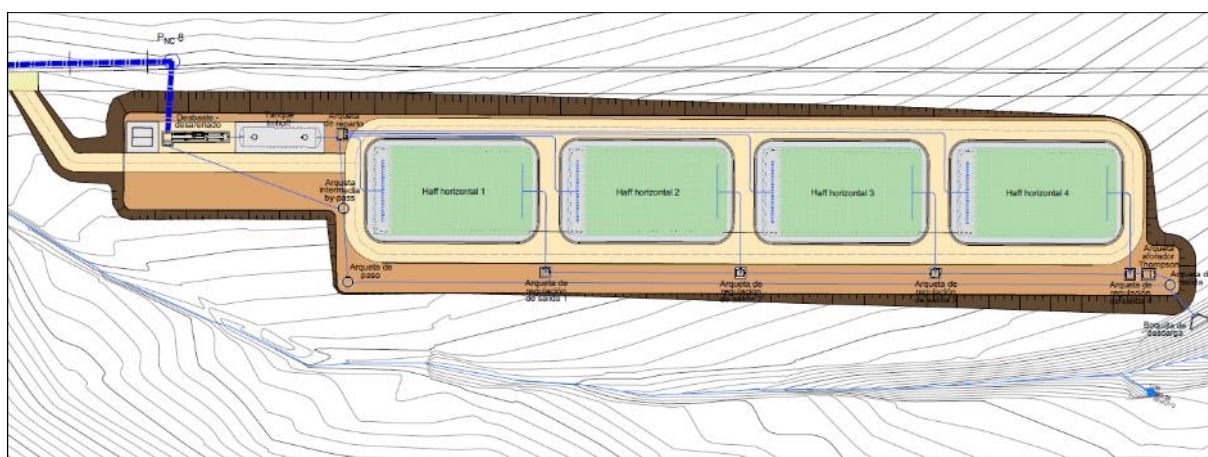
DISTRIBUCIÓN EN PLANTA
